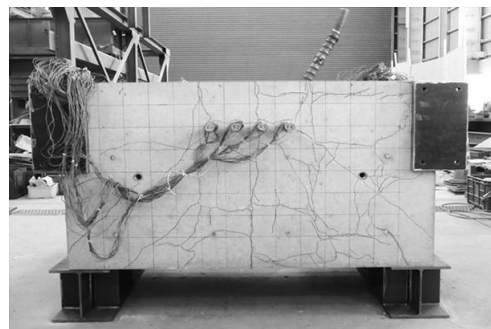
Case-3 供試体上面のコーン状のひび割れ (載荷終了時点)
